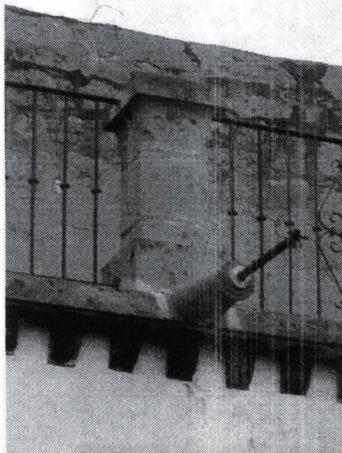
Barandal de hierro forjado y pilarote, corredor poniente patio posterior, nivel planta alta.
